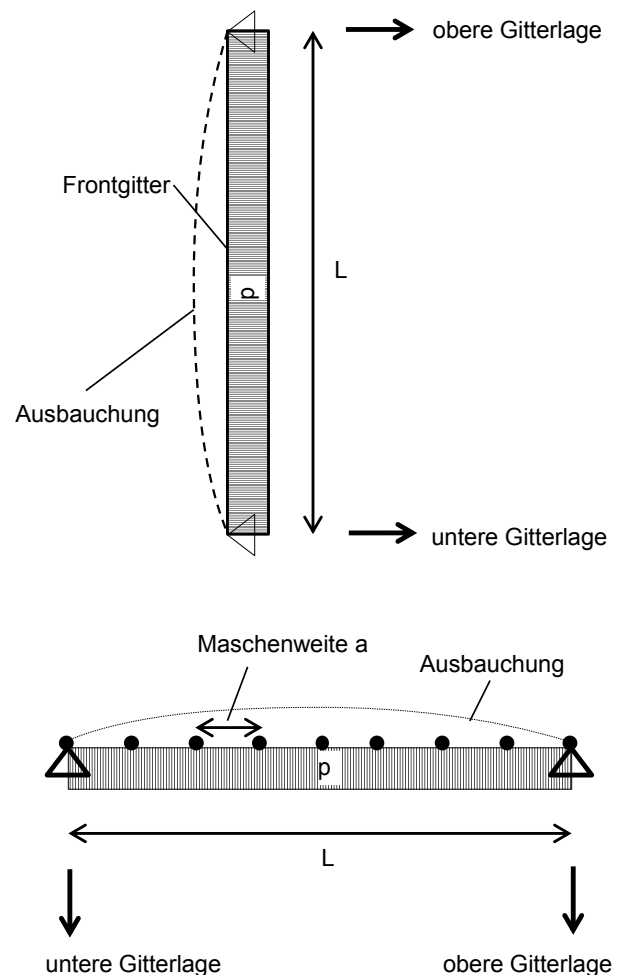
Gabionendraht als biegeschlaffes Seil; oben: Querschnitt, unten: Grundriss (in Anlehnung an: [13])
